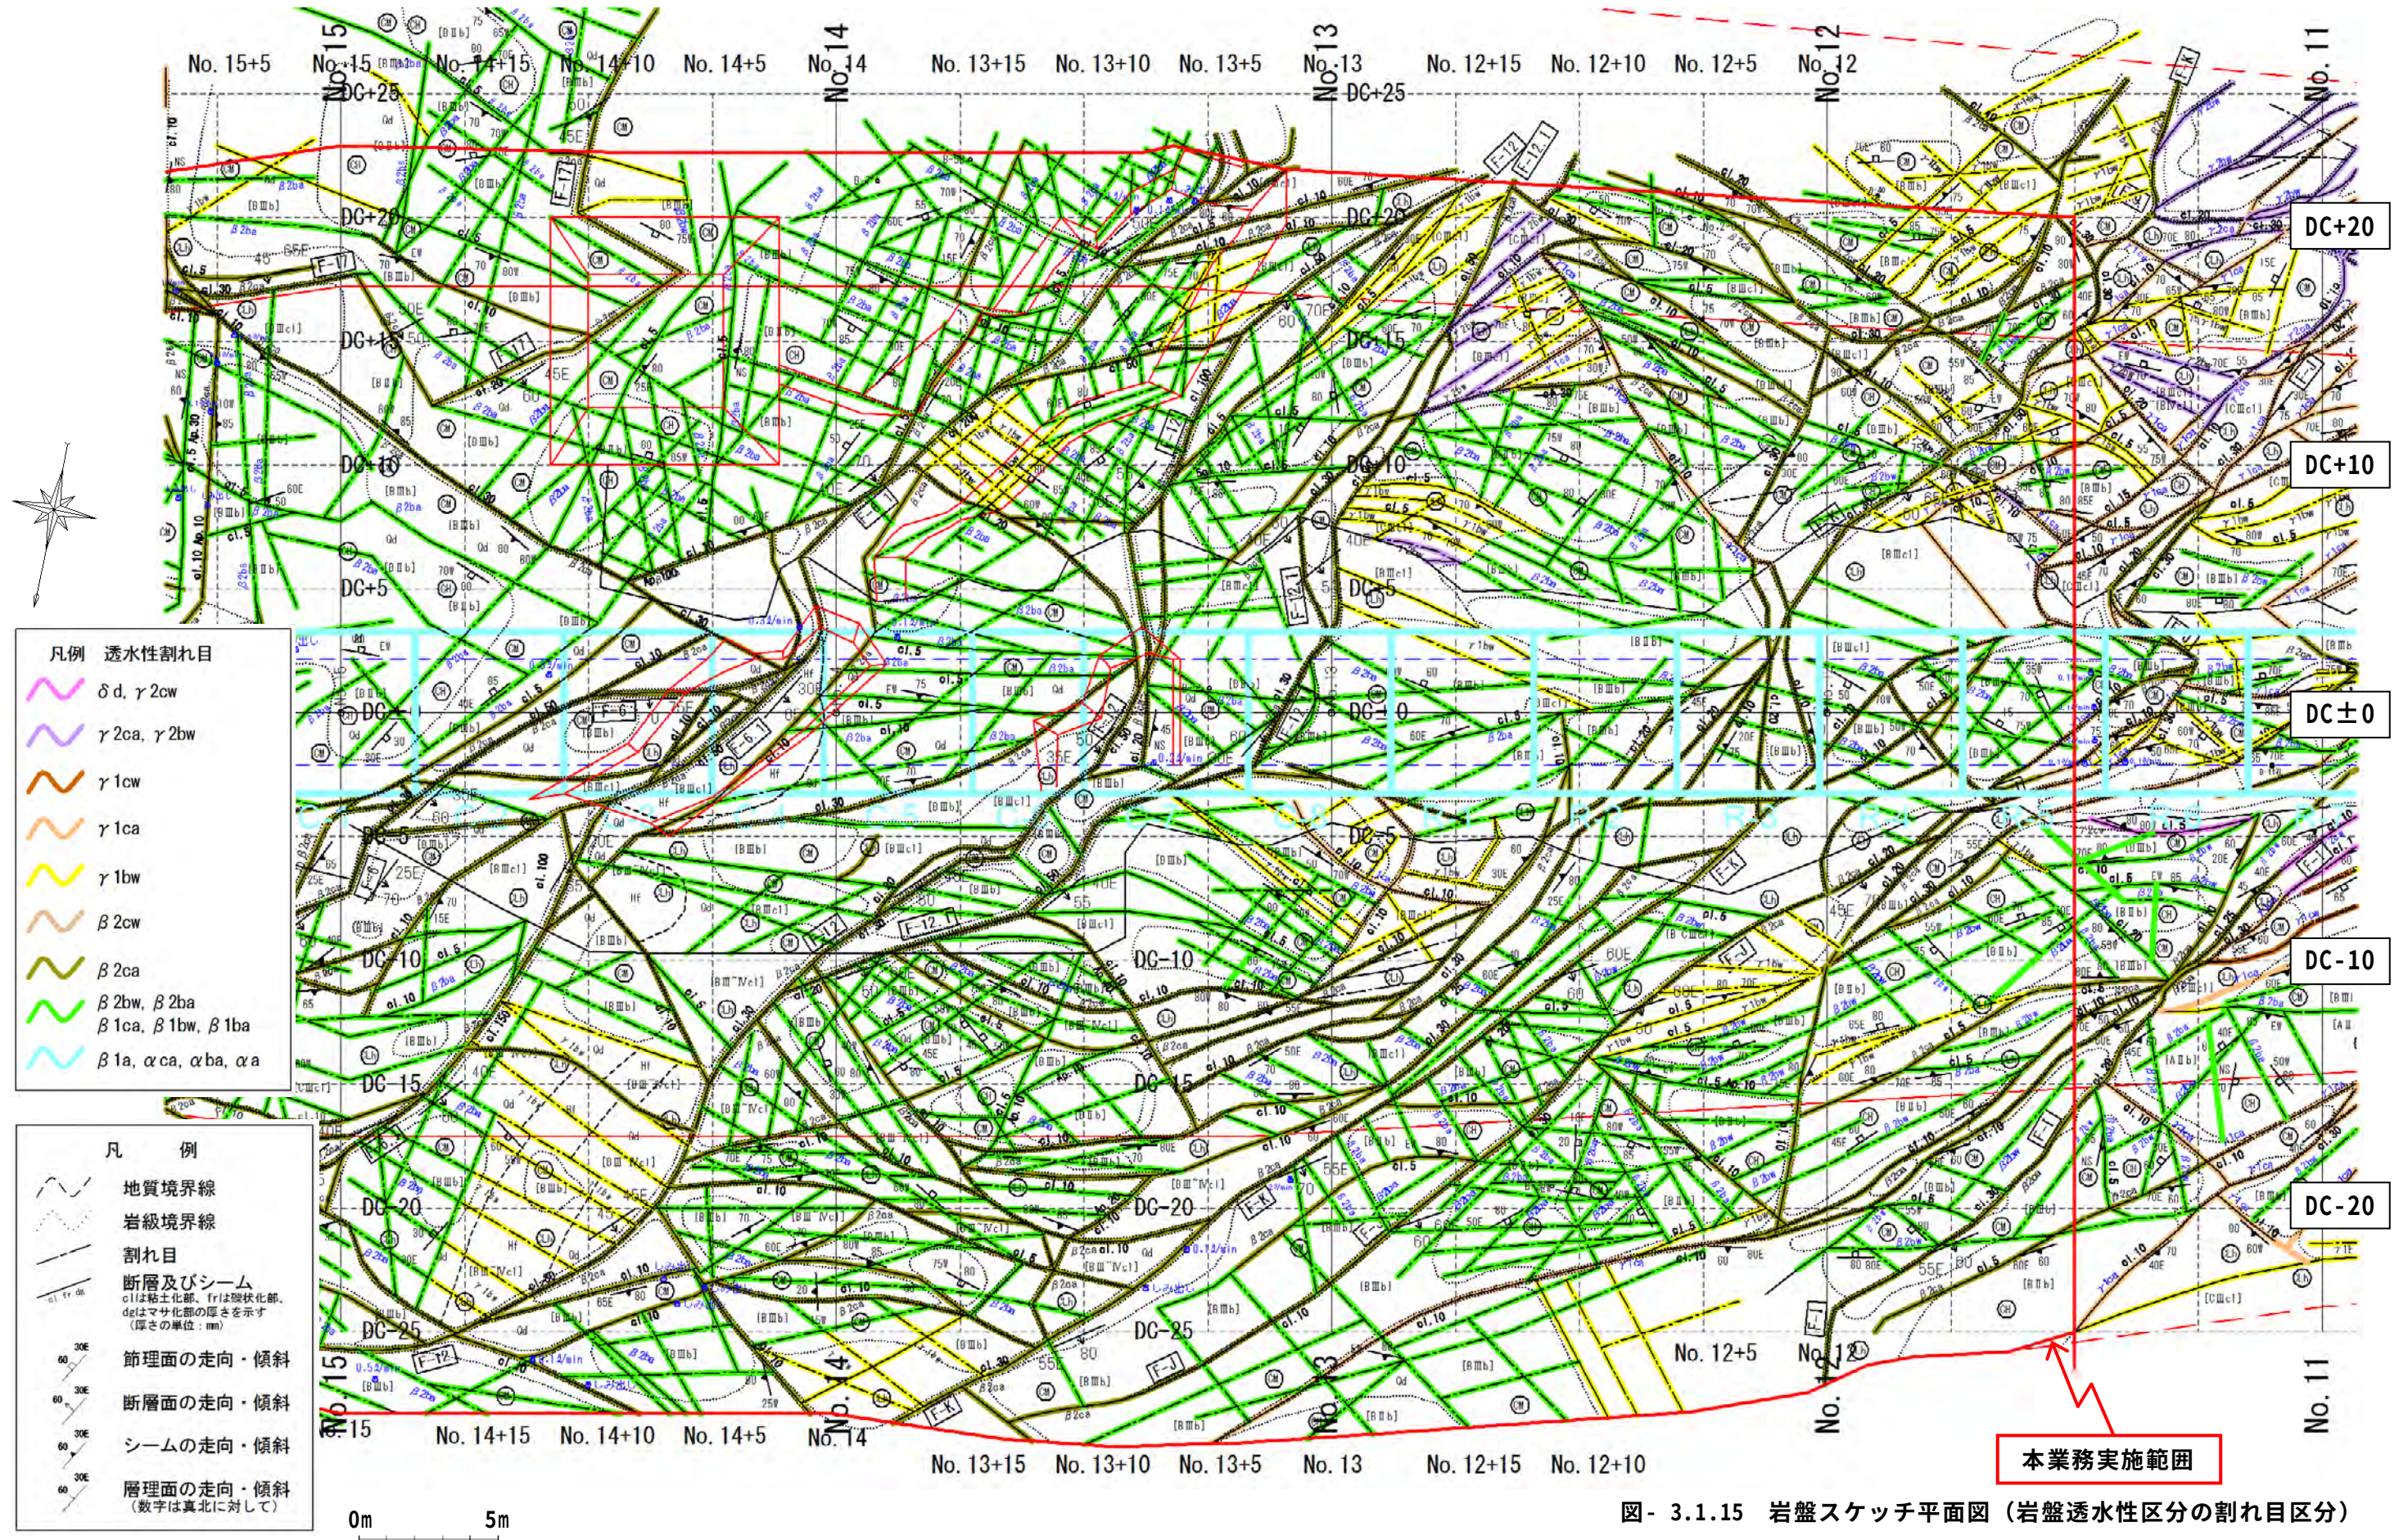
岩盤スケッチ平面図 (岩盤透水性区分の割れ目区分)
